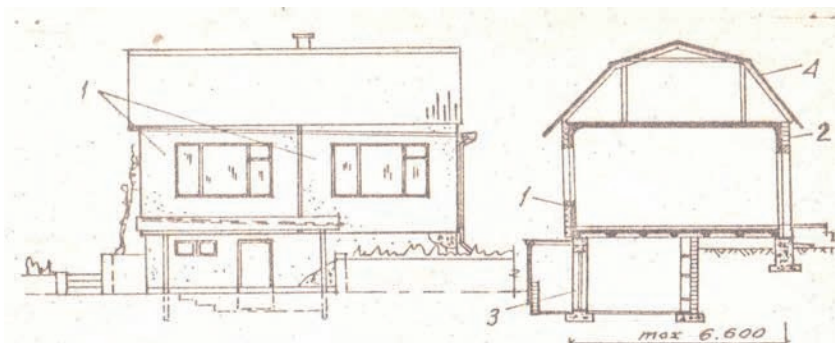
Садовый домик с применением объемных блоков (для многоэтажных зданий):
